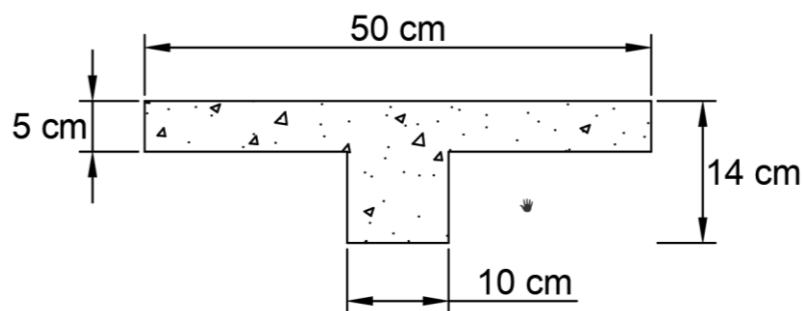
Sección de losa propuesta para entepiso y cubierta
